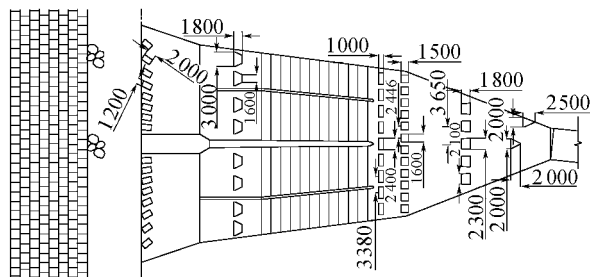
入海口水工建筑物的最终设计纵平面(单位:mm)
